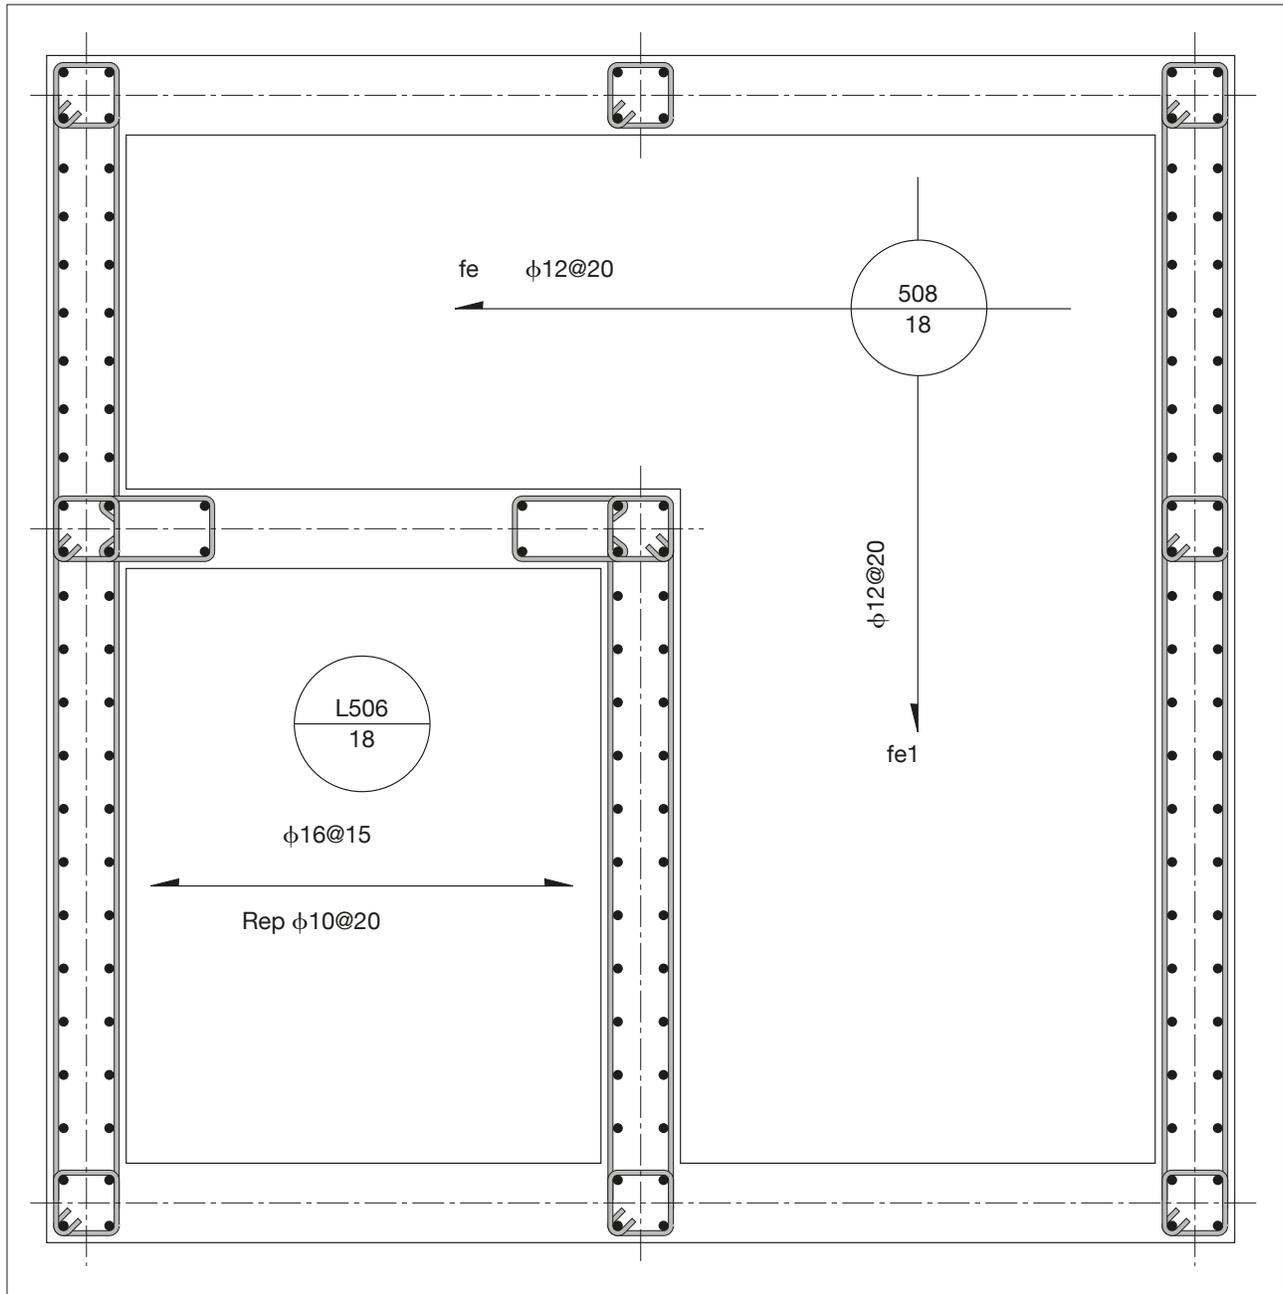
Plano de Conjunto Losas 506 y 508 (fuera de escala).
